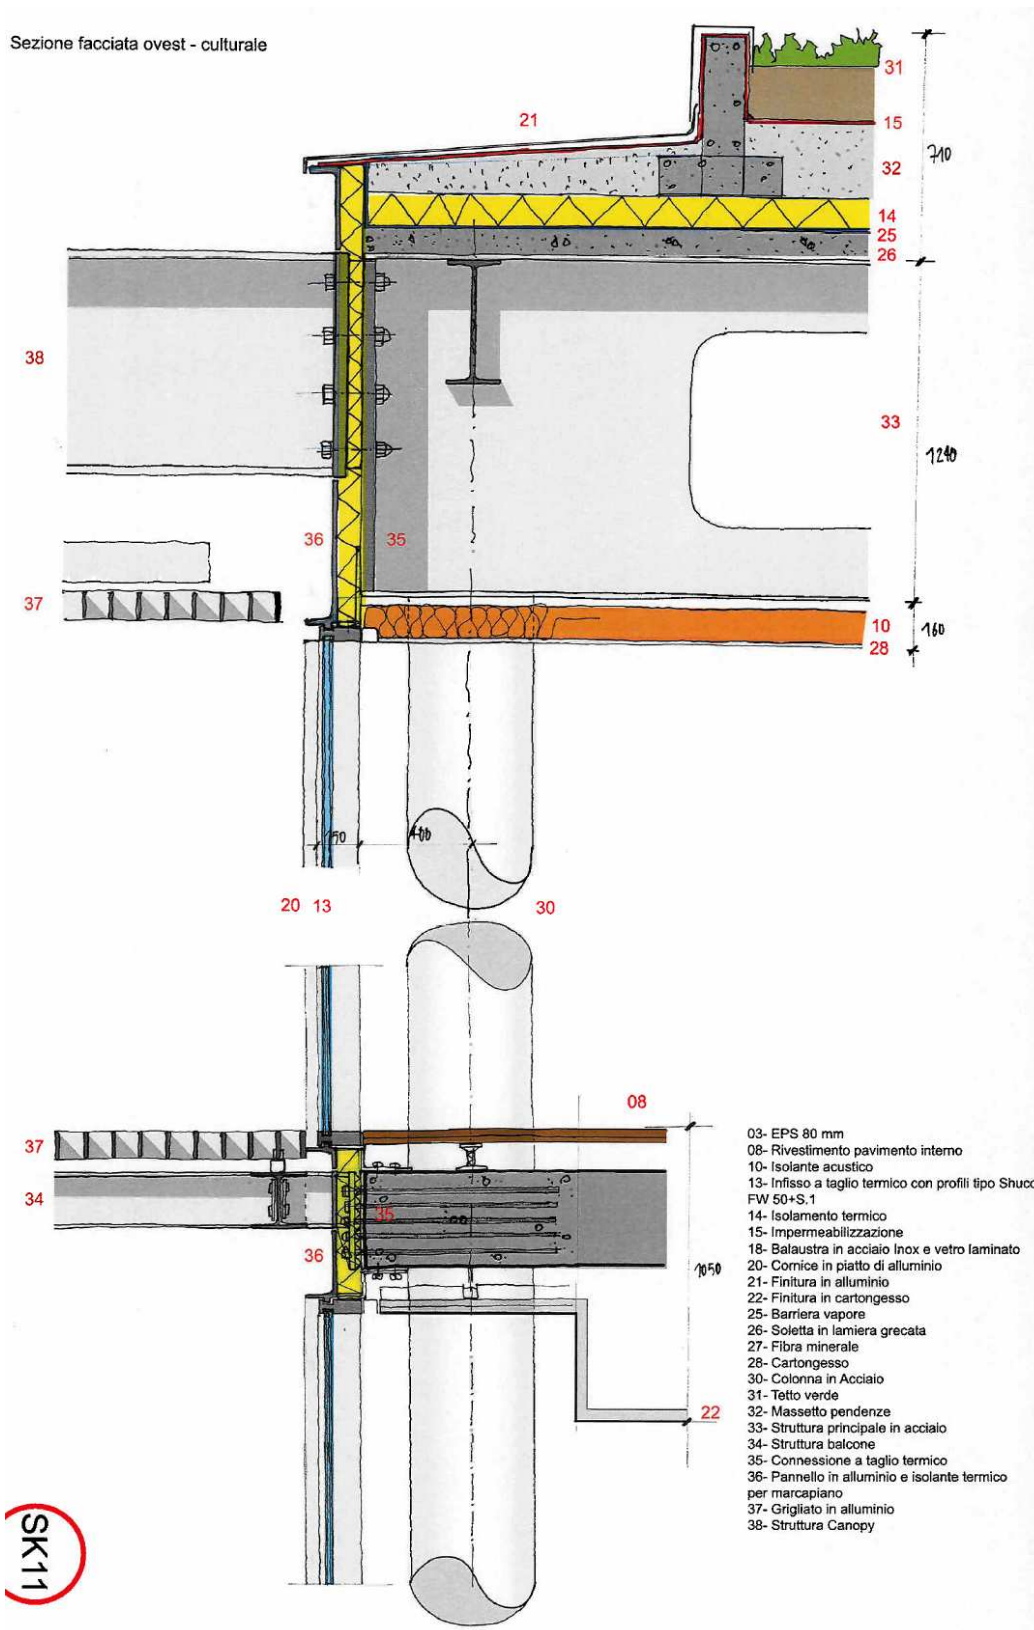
Indicazione in sezione degli elementi leggeri di facciata non rigidamente connessi
